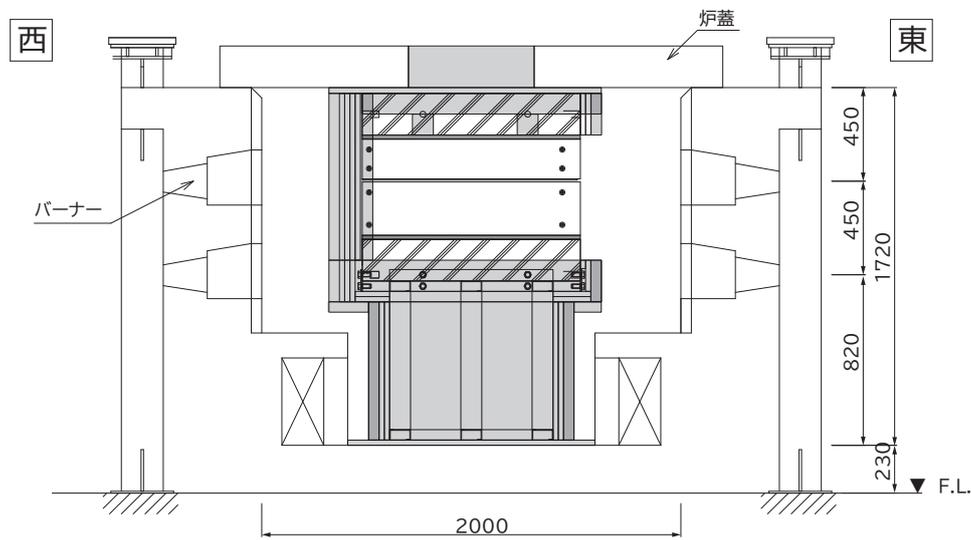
留付間隔拡大品質性能試験 試験体 東西立面図
